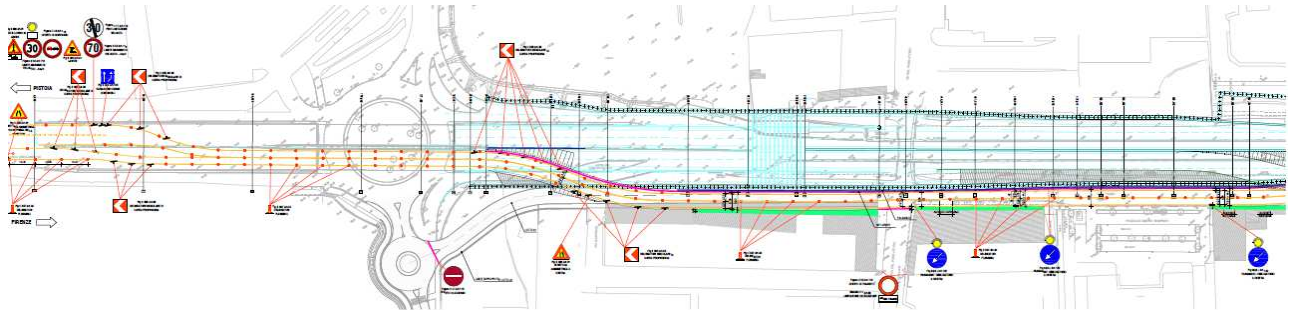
Planimetria deviazione provvisoria fase 2 (parte 1)
